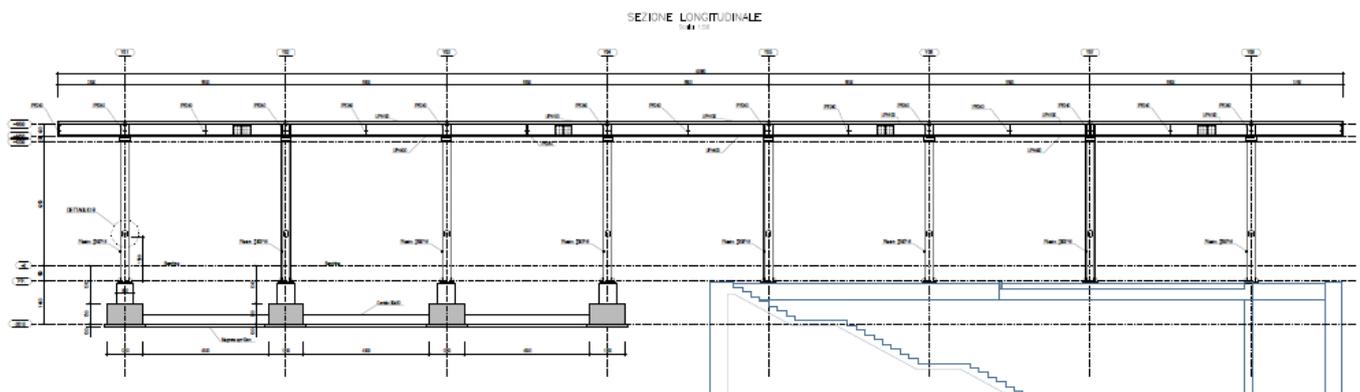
Pensiline – Sezione longitudinale - - Pensilina Nord
